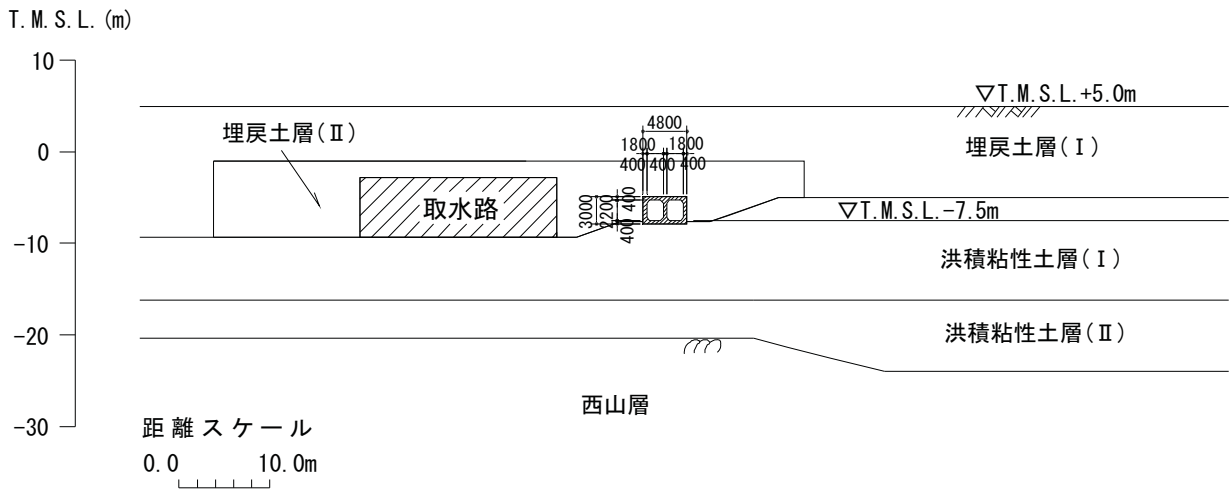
補機冷却用海水取水路断面図 (C-C断面)
